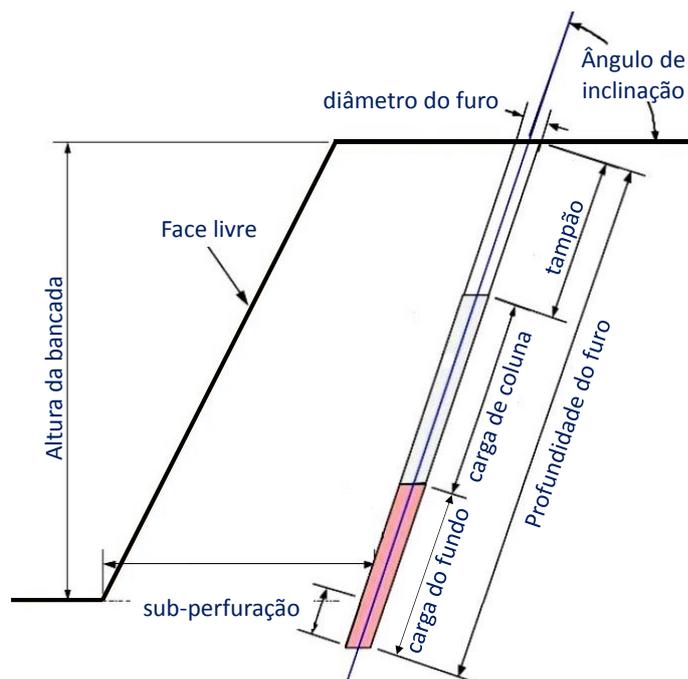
Geometria de uma bancada e elementos típicos de um plano de fogo (adaptado de Silva, 2013).
